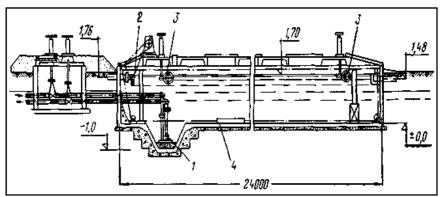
Типовая нефтеловушка пропускной способностью 30 л/с. 1 - гидроэлеватор; 2 - распределительное устройство; 3 - нефтесборная труба; 4 - скреперный скребок
